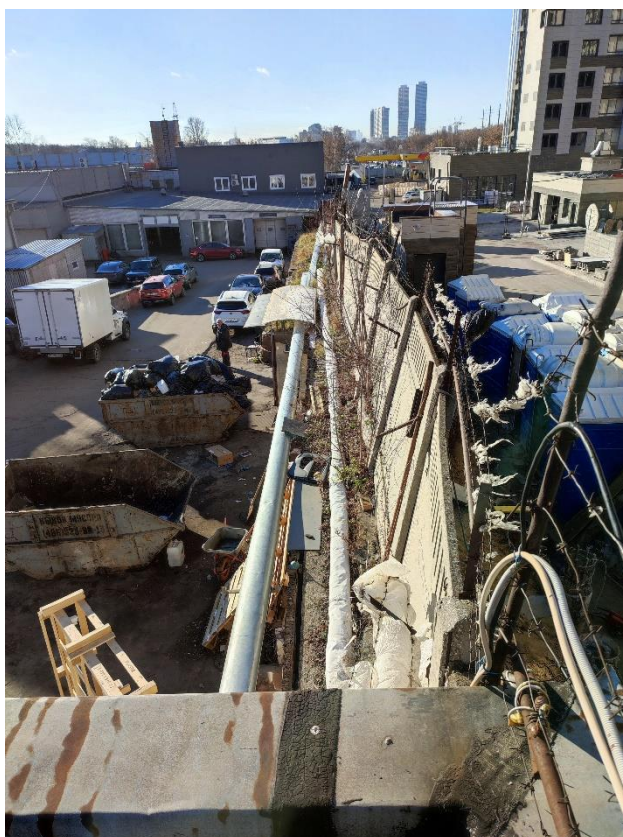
Отклонение от вертикальной плоскости забора, примыкающего к зданию в осях 1/А
